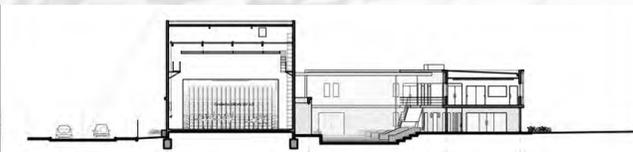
Elevación arquitectónica Interior Centro Cultural Alto hospicio.
